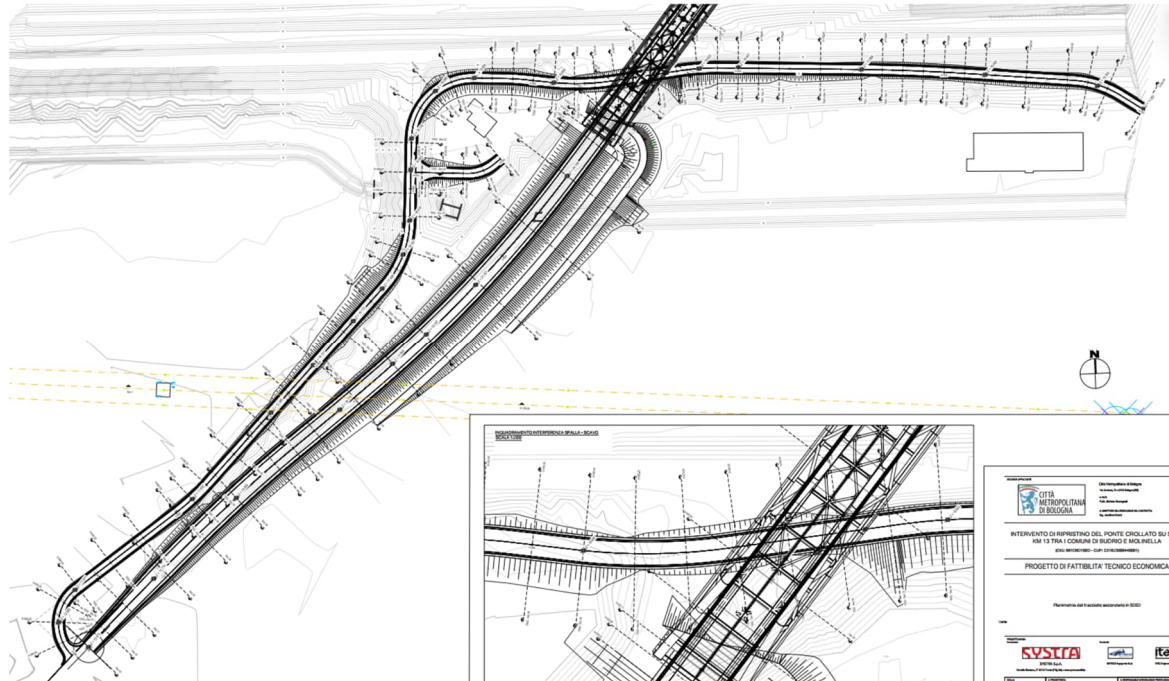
Planimetria del tracciato secondario in sponda destra idraulica
